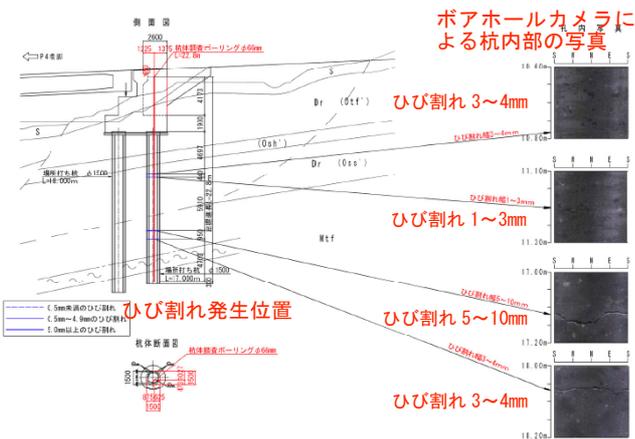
橋台(図-1 右側)の基礎杭のひび割れ発生位置
